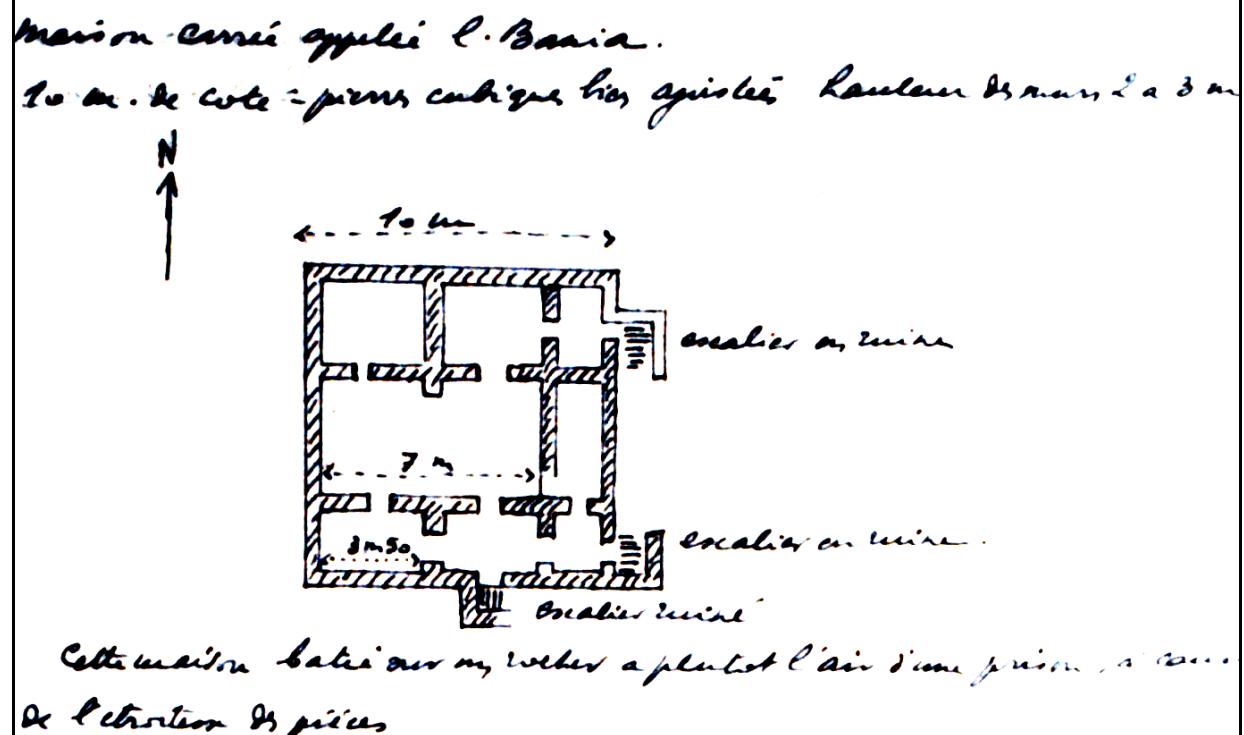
Croquis d'une structure fortifiée de Hr. El Beinnaia (n° 158)
